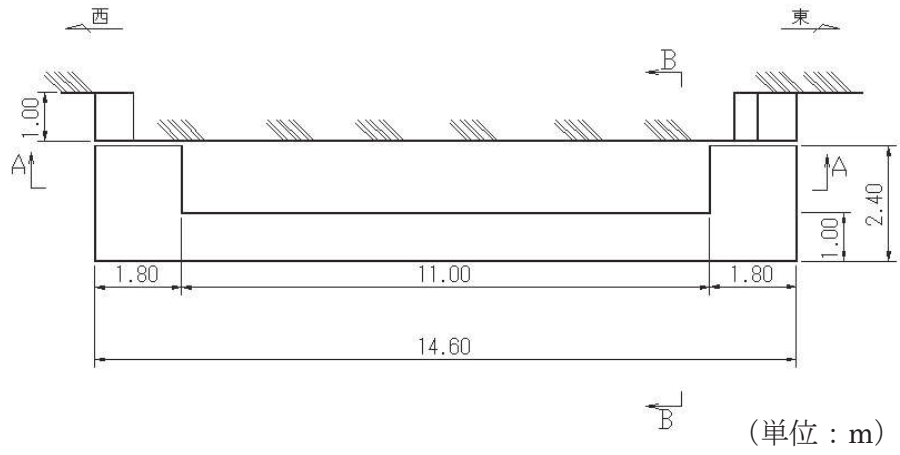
第 3 号機補機冷却海水系放水ピット平面図 (C-C 断面)
